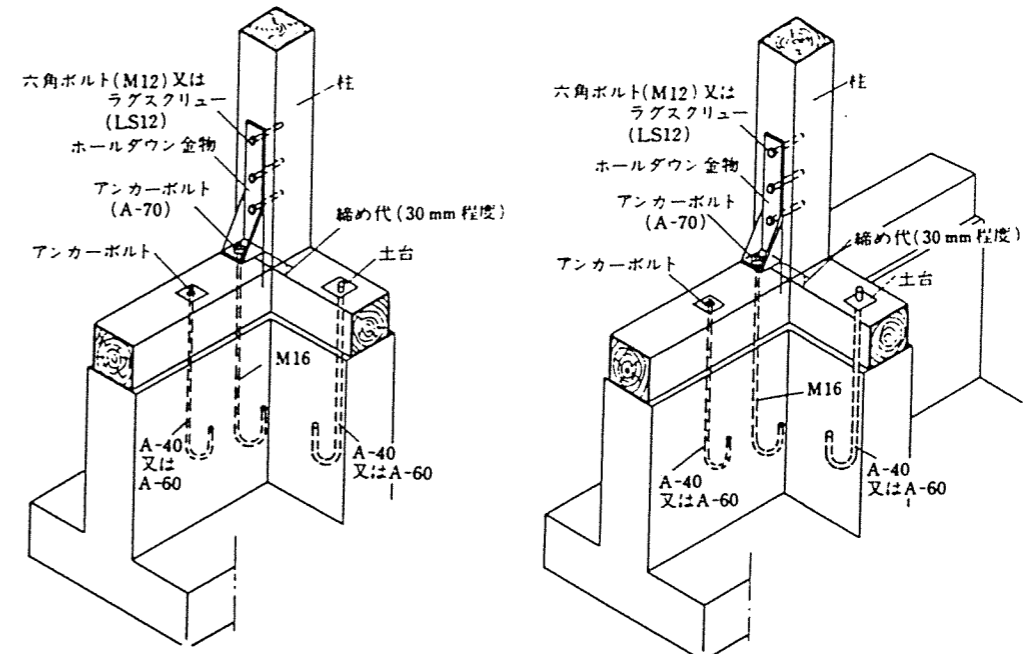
ホールドダウン用金物を用いたアンカーボルトの緊結
